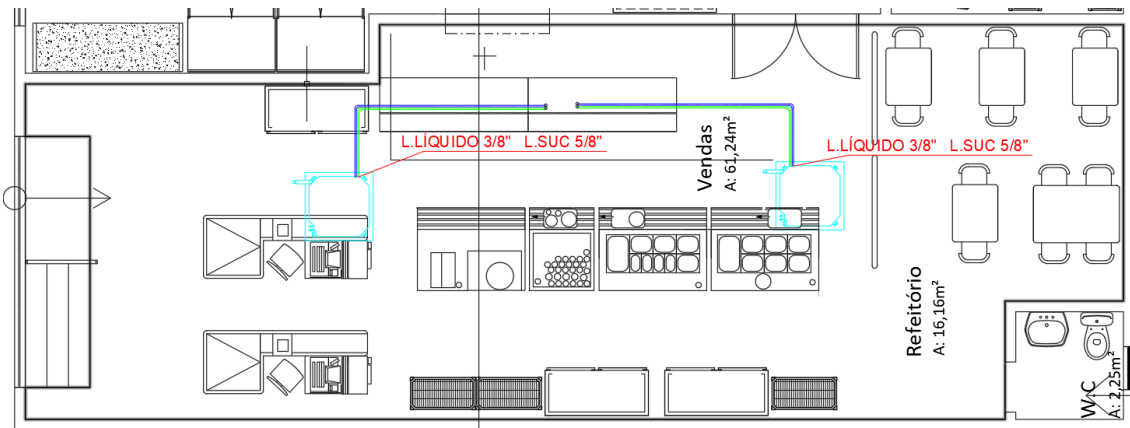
Planta baixa Sistema de Ar-condicionado Cassete
